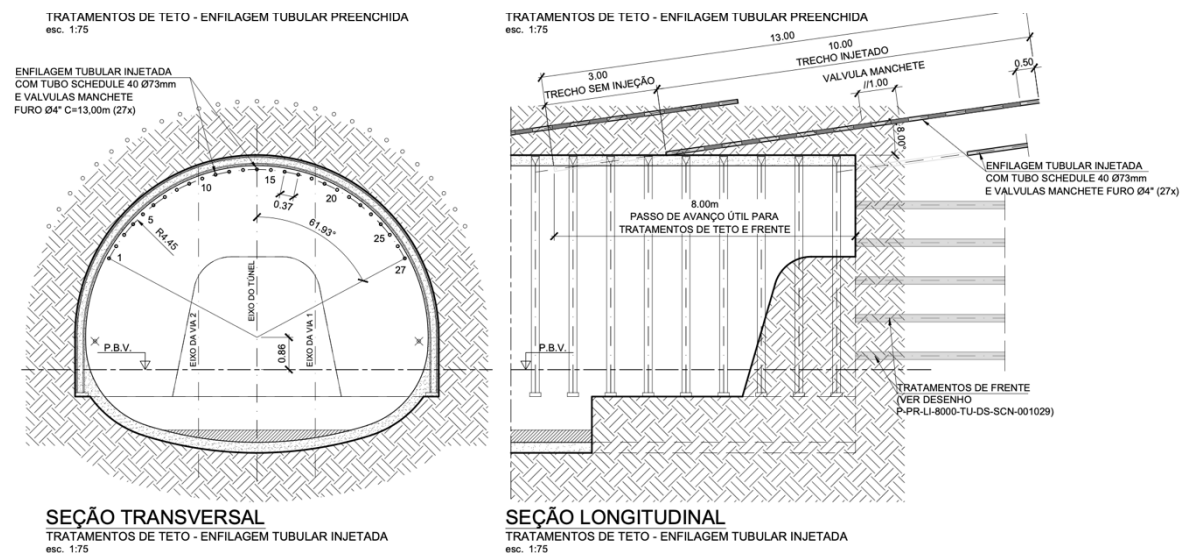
Liberdade/Boavista-Casa da Música-Túnel Via Dupla – Tratamento de tecto “Enfilagem Injectada”. Fonte: P-PR-LI-8000-TU-DS-SCN-001028-01
